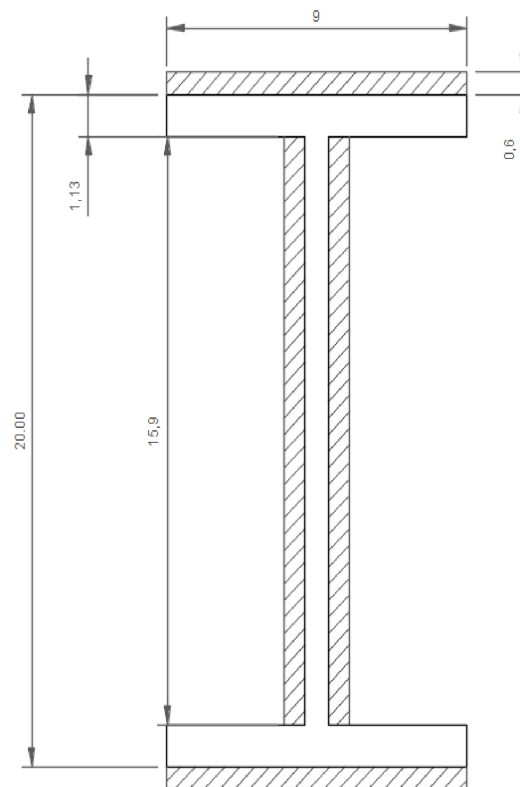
Perfil IPN200 y filetes de soldadura
